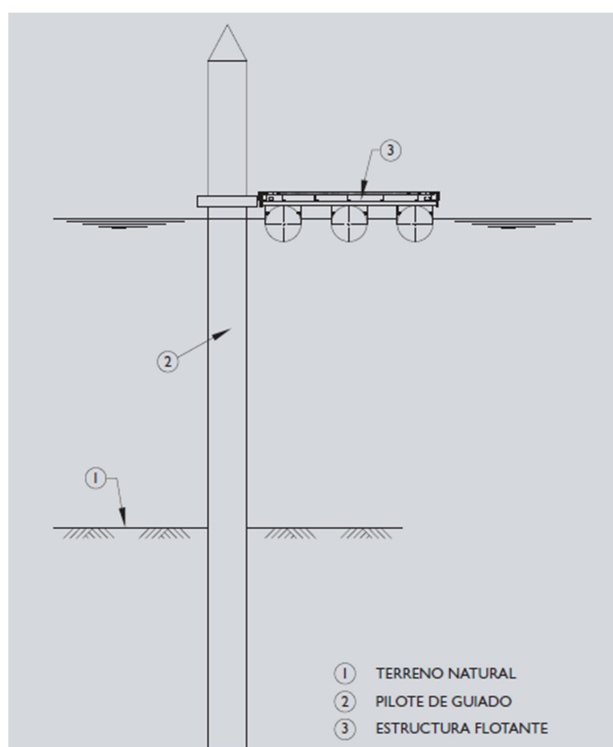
Pantalan flotante guiado con pilotes. Sección tipo (Fuente: ROM 2.0-11)
